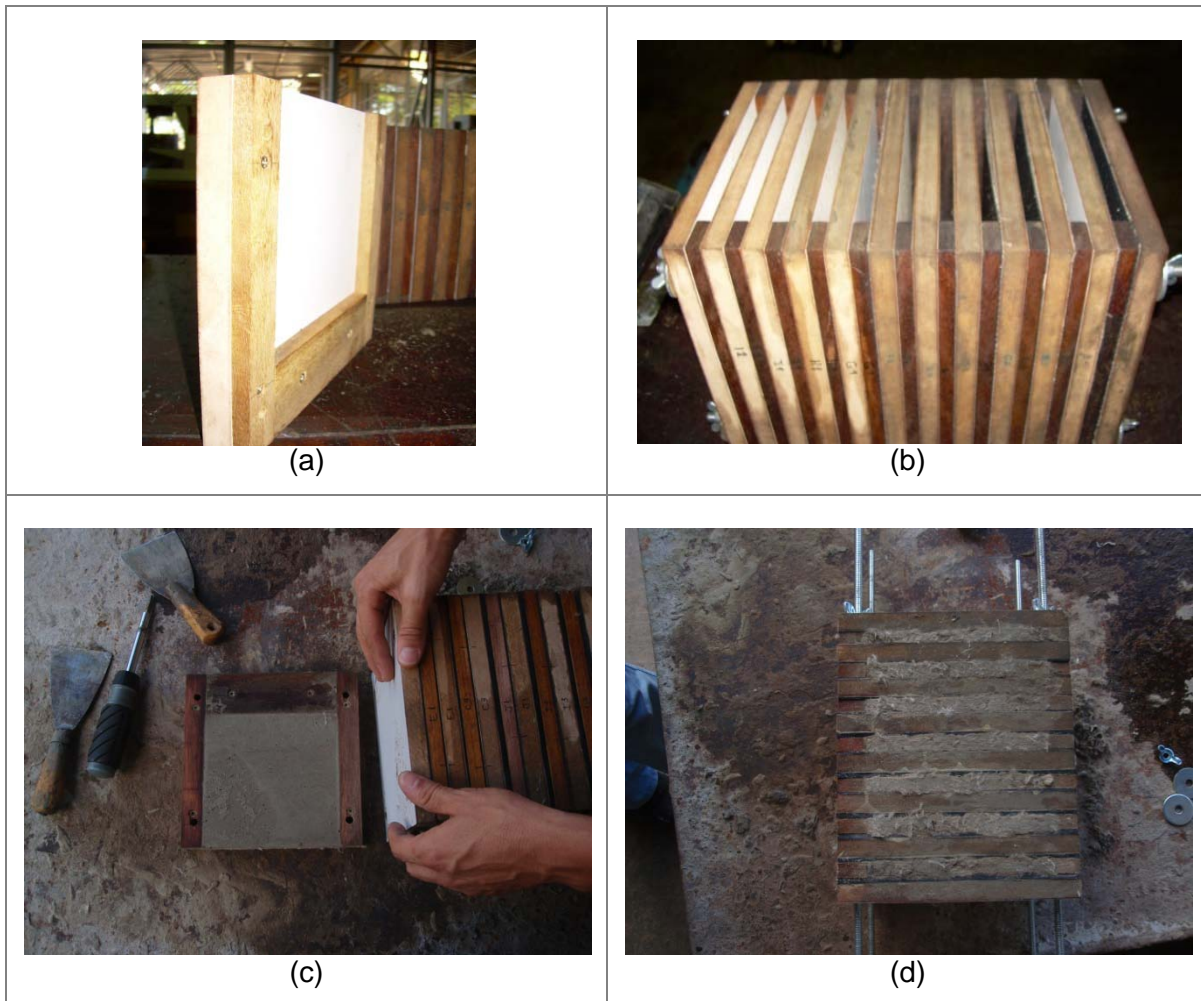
(a) Foto de uma fôrma da almofada; (b) Foto da fôrma completa – Bateria; (c) desmoldagem de cada placa; (d) Bateria com as placas prontas para desmoldar.
